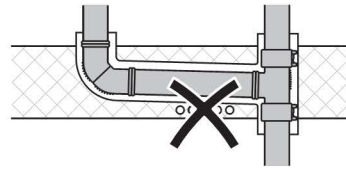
Kreuzungen mit einbetonierten Wasserleitungen oder Elektroröhren sind zu vermeiden. Sie erhöhen die Schallwerte je nach Bausituation um 3–10 dB(A).
